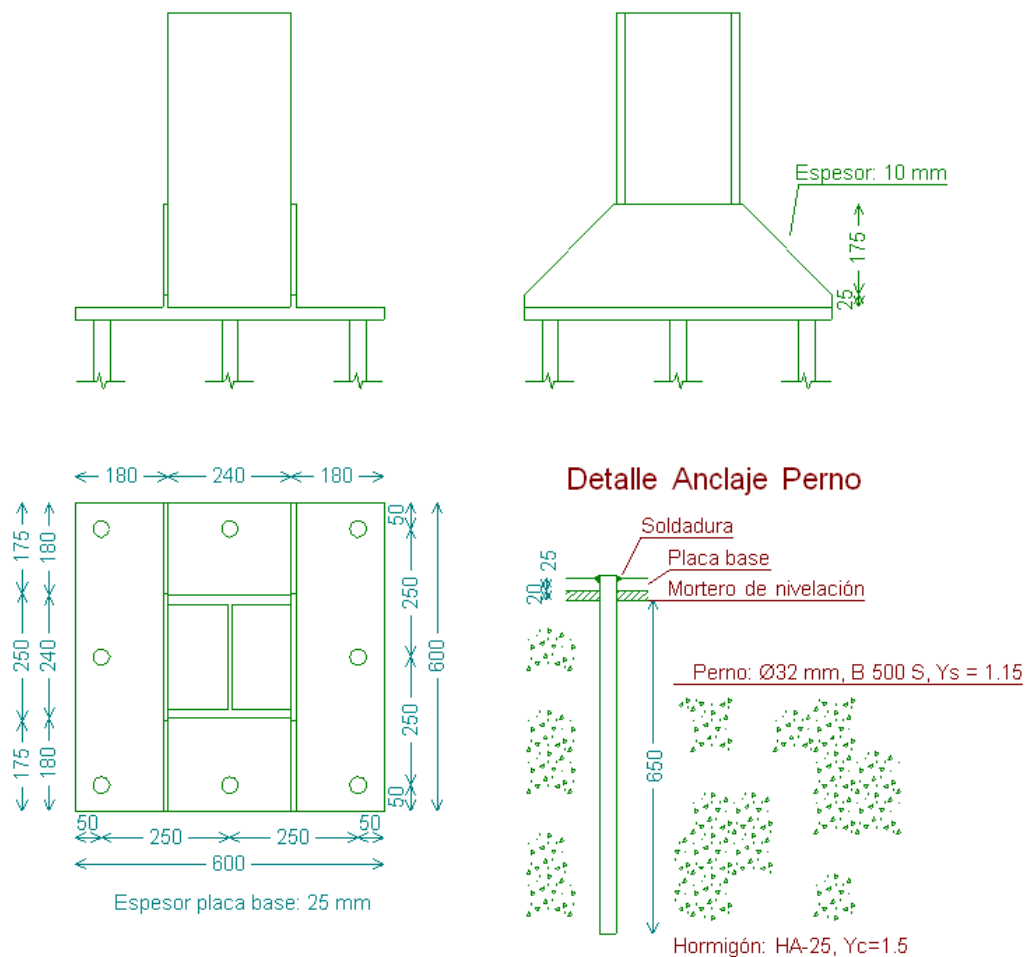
Placa de anclaje pilares de fachada extremos
